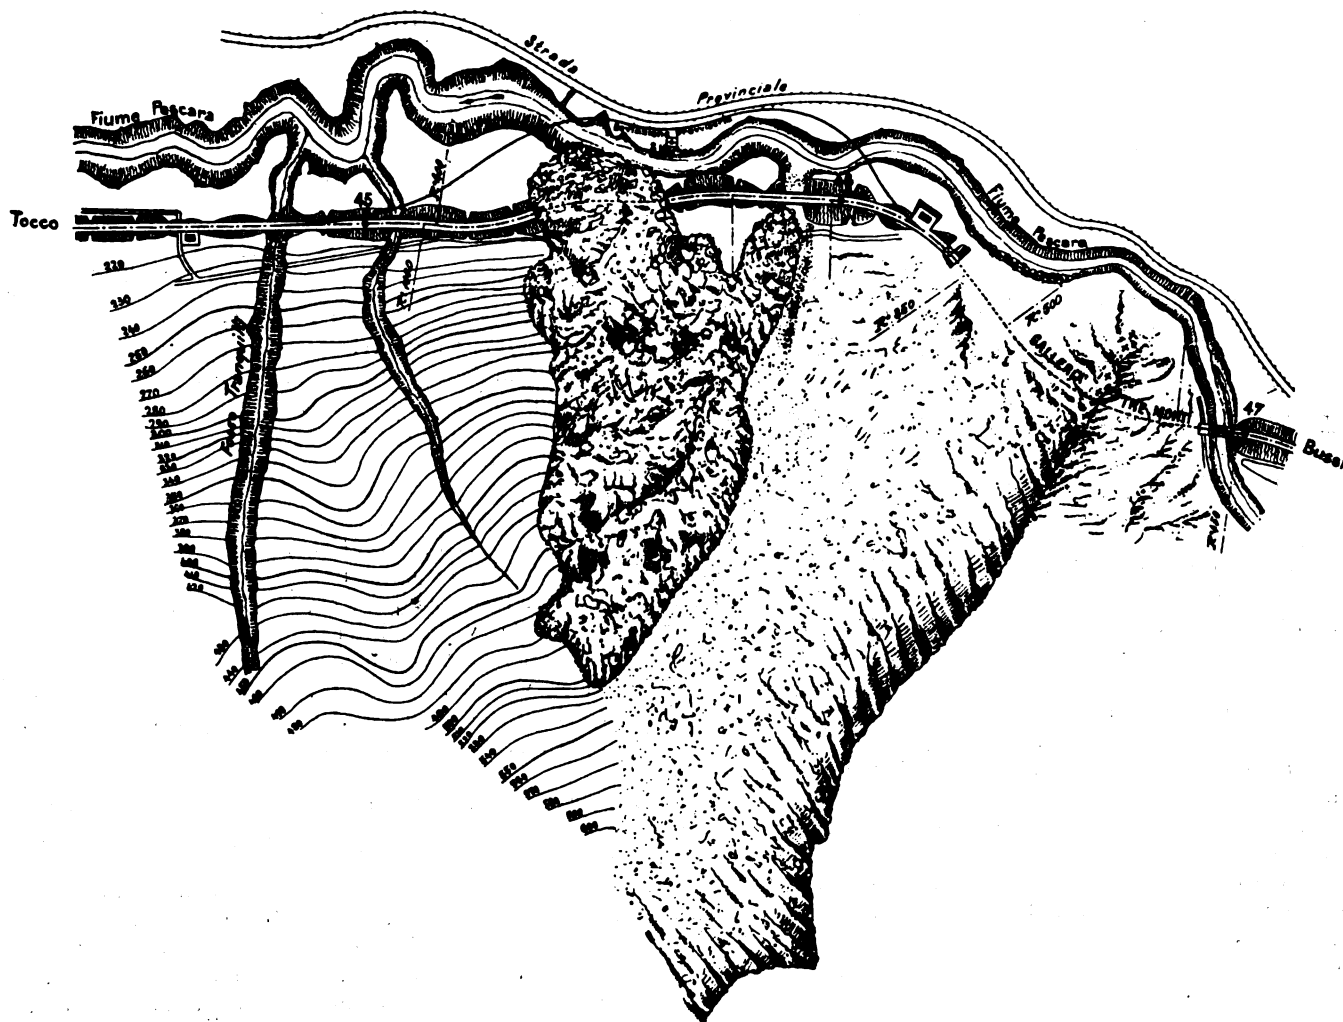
Frana di Bussi - Schizzo planimetrico.
